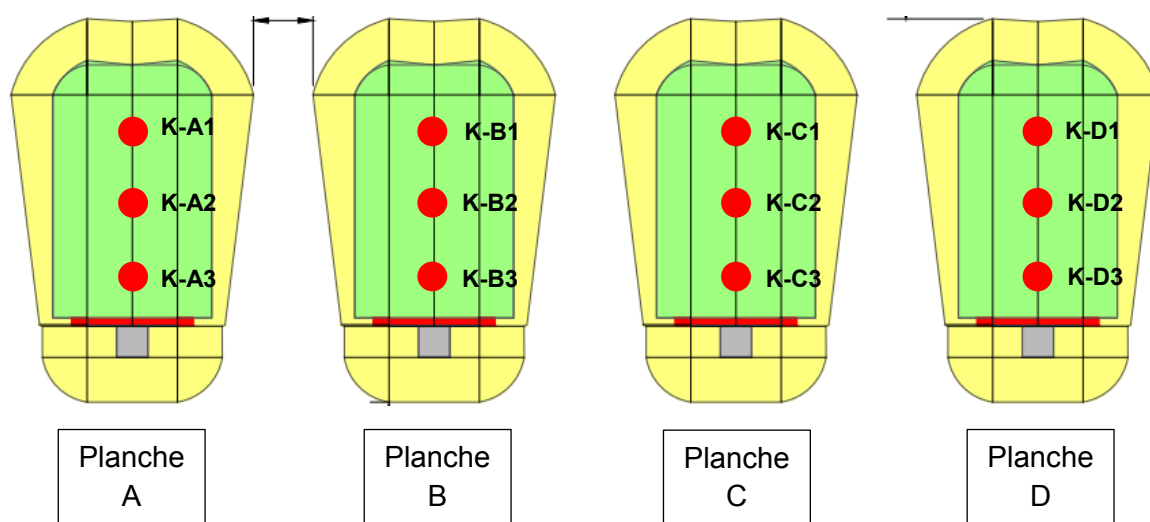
Schéma d'implantation des essais de conductivité hydraulique au simple anneau sur les quatre planches d'essais
